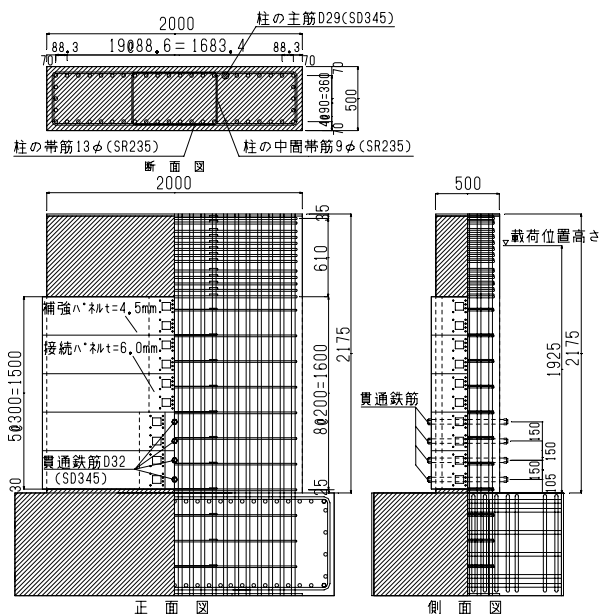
試験体の概要(貫通鋼材は B 試験体のみ)
